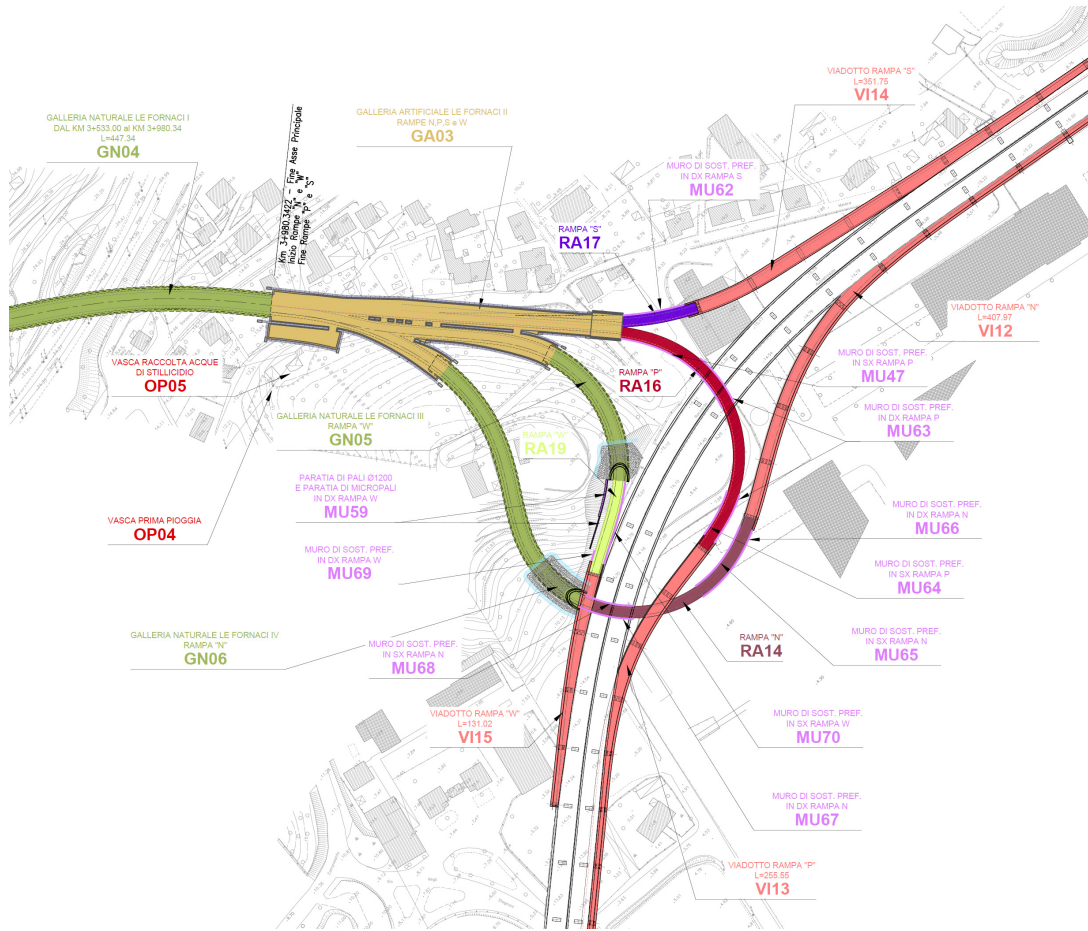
Stralcio planimetrico dello Svincolo Melara
